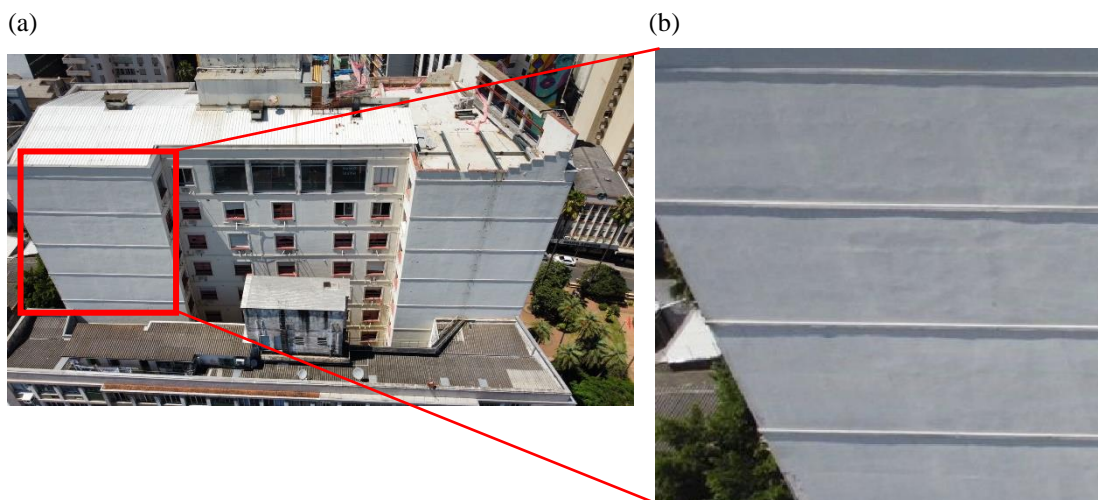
(a) localização e (b) inspeção de trecho da fachada.
